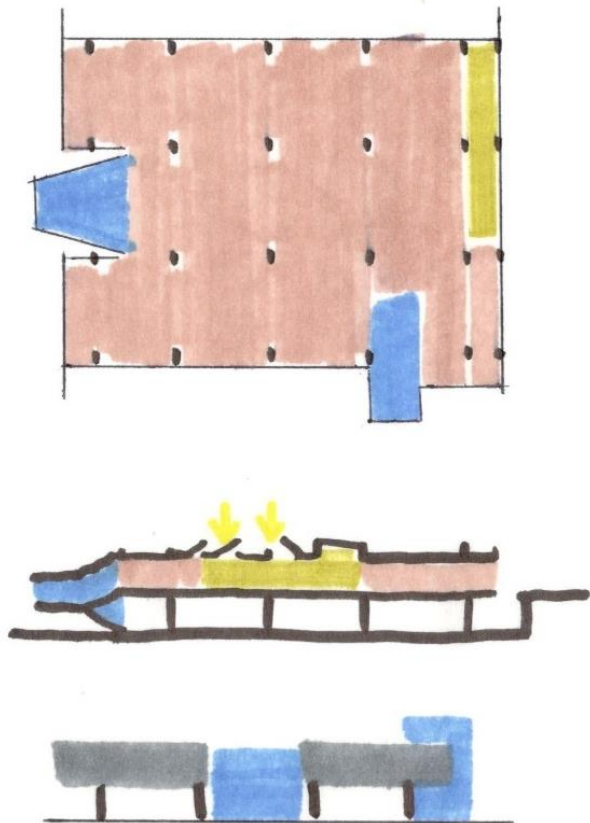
Editora Tibagi. Um pavimento é elevado sobre pilotis conferindo espaço de estacionamento no térreo e planta livre no pavimento superior. Em corte, valoriza-se a iluminação zenital para os espaços de serviço. Na fachada tem-se a circulação vertical principal ao centro e aos fundos o volume de circulação de serviço.
